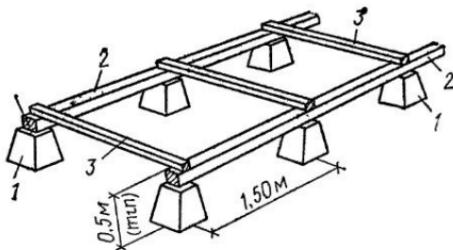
Фрагмент основания для штабеля пиломатериалов
